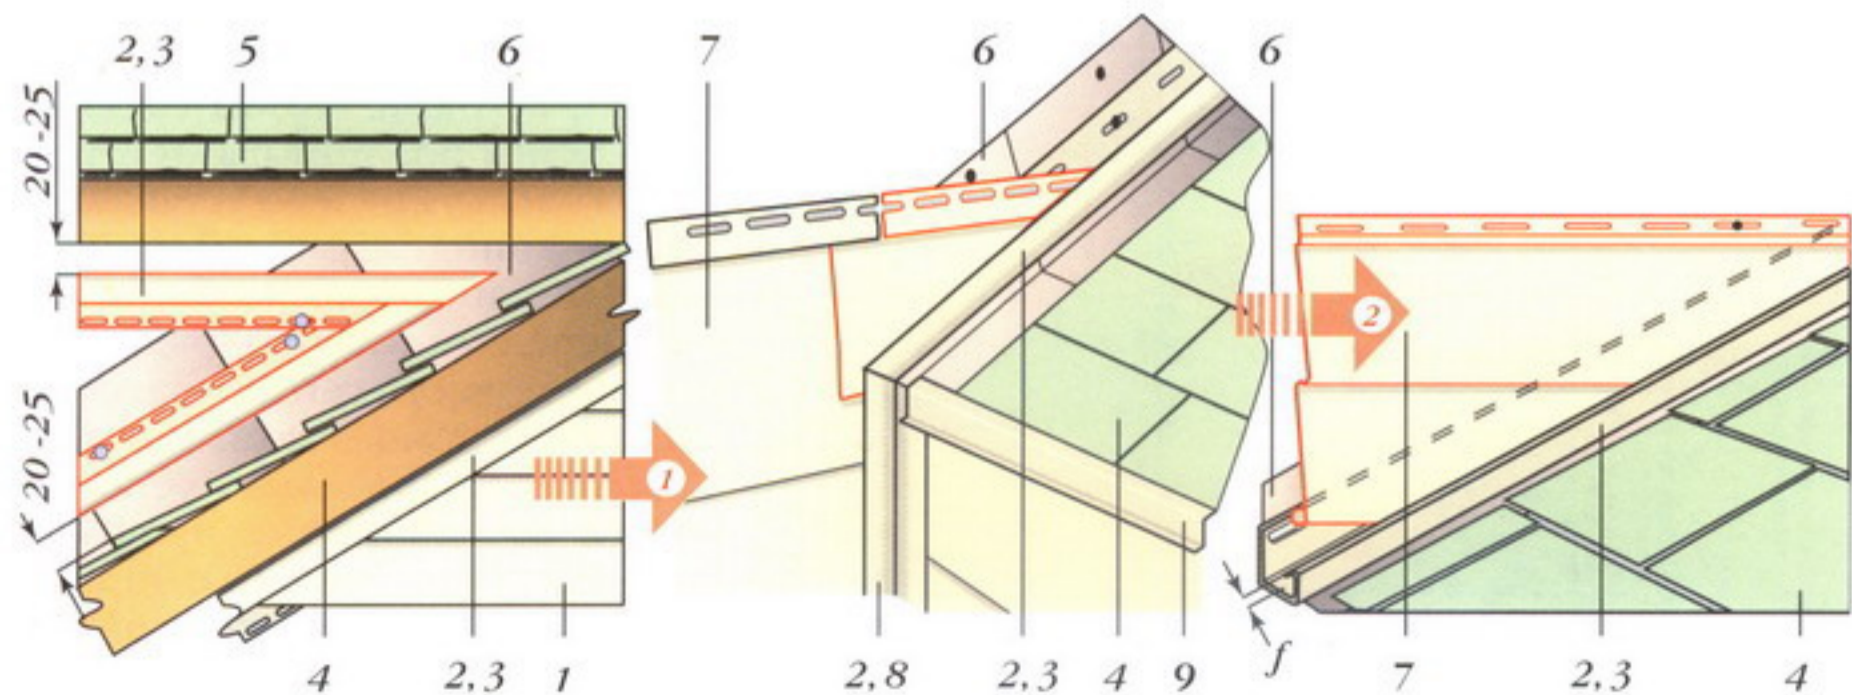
Обшивка сайдингом стен, примыкающих к крышам (размеры в мм): 1 — обшивка фронтона; 2, 3, 8 — J-профиль (2), или виниловая доска (3), или угловой профиль (8); 4 — крыша над фронтоном; 5 — крыша над стеной; 6 — гидроизоляция из жести; 7 — панель сайдинга; 9 — фаска; f — температурный зазор
